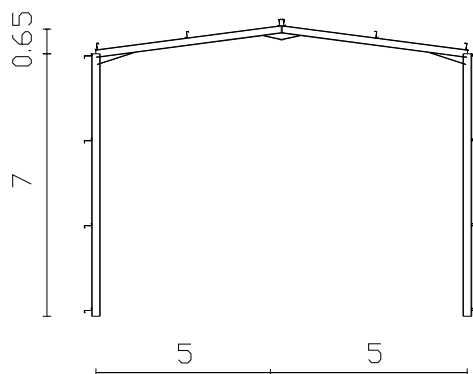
Pórtico rígido viga e pilar de alma cheia, vão de 10.00m com esquadros ligação pilar/viga, viga/viga
